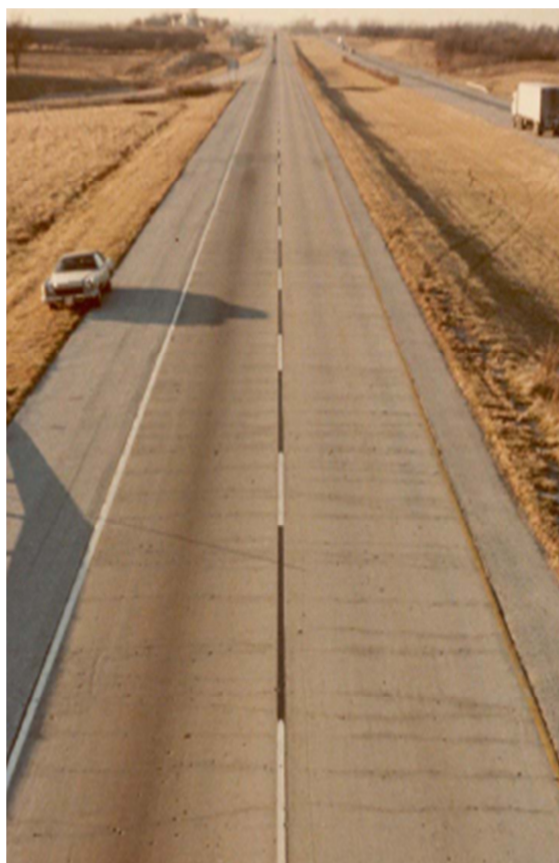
2 - Fissuração em um PCCA (ROESLER, 2005)
